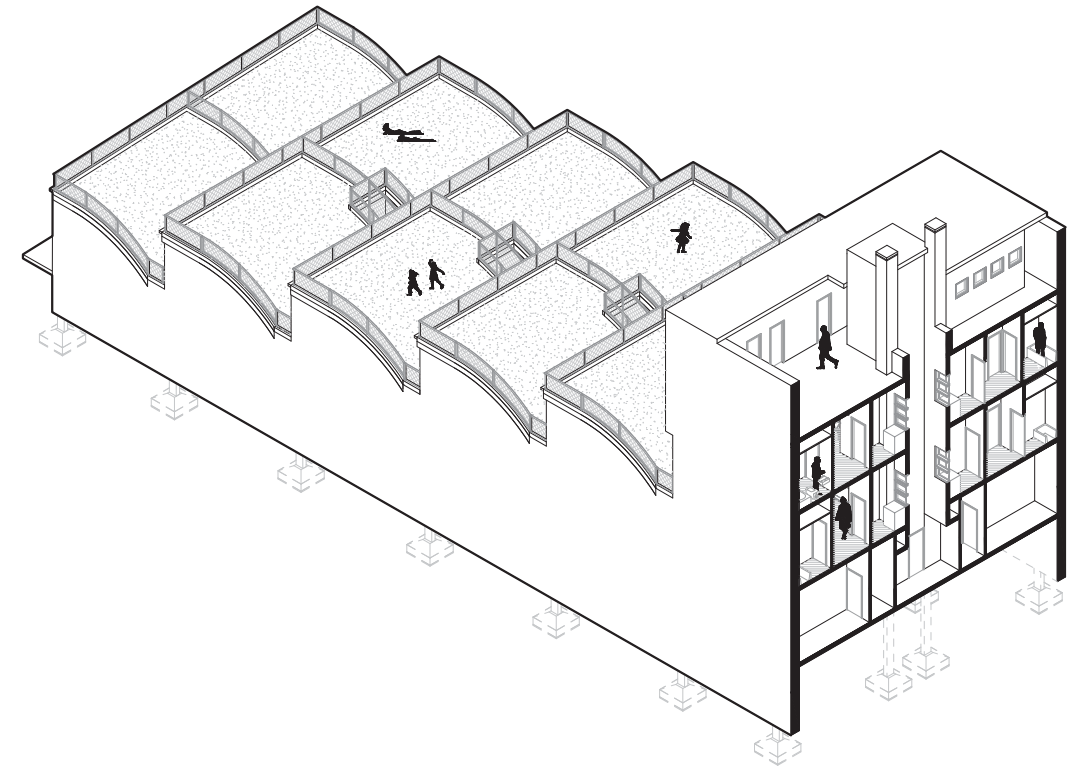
Axonometría seccionada transversalmente por cuerpo elevado
